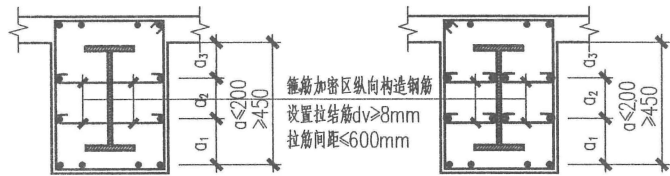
型钢混凝土梁纵向构造钢筋构造要求
